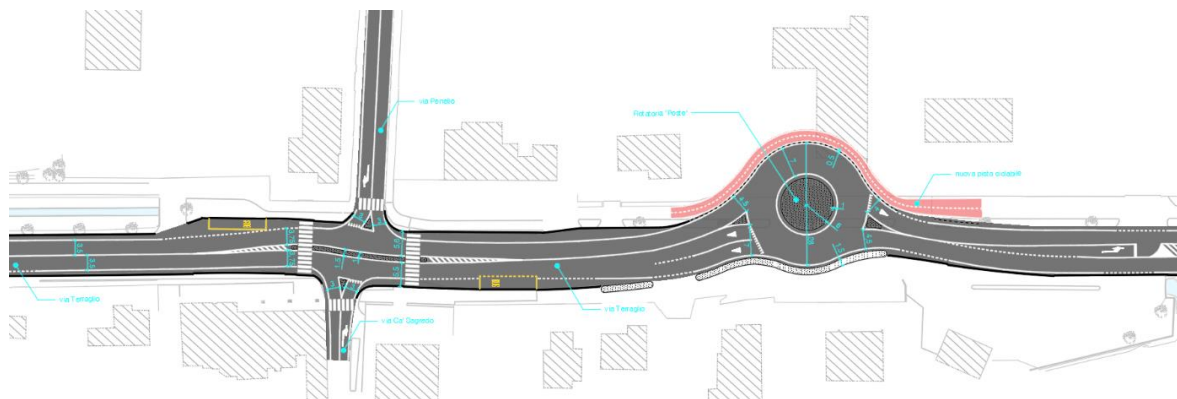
Estratto tavola 2.02 - Stato di progetto: planimetria di progetto 1.1
